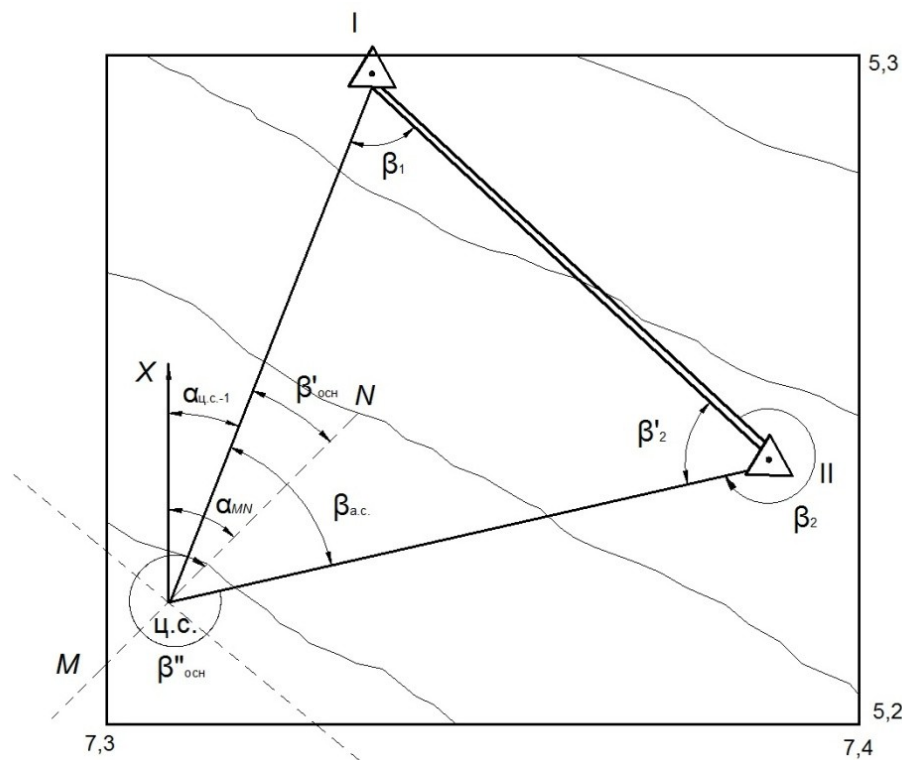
План разбивки центра вентиляционного ствола и строительных осей
